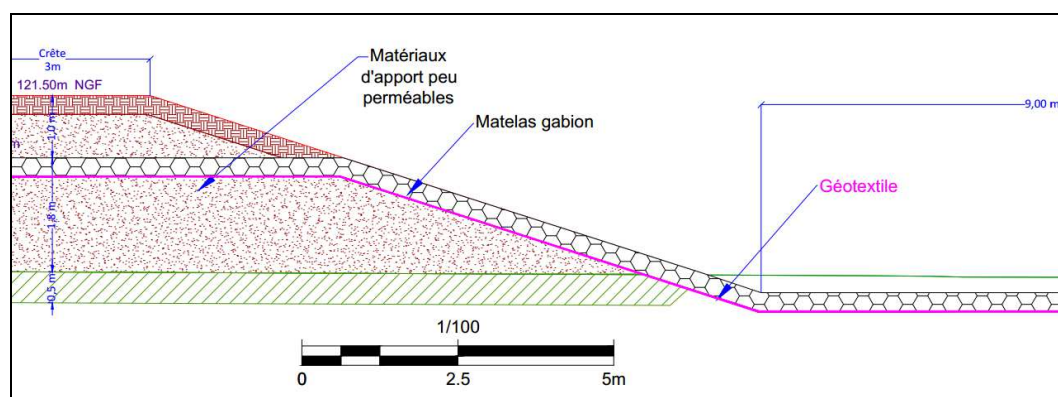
Ouvrage D19-8 - Coupe en travers du corps de l'ouvrage (parement aval)
